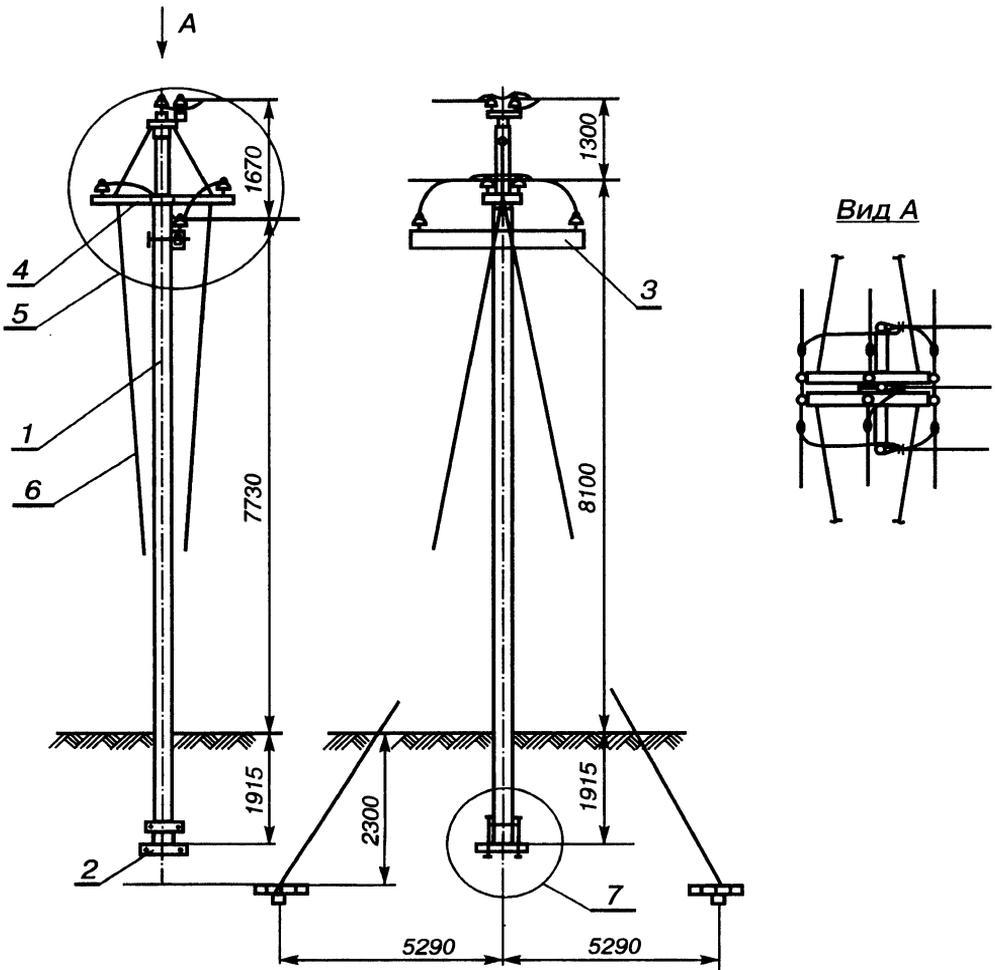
Размещение оттяжек на ответвительной опоре
